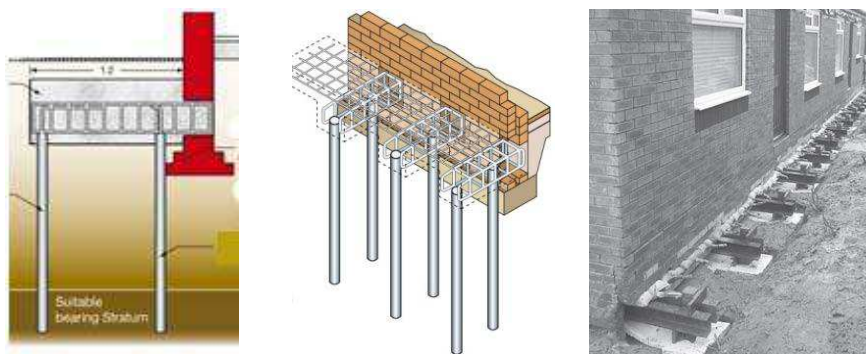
Ojačanje temelja primenom grede i šipova [Savić i dr., 2013]
